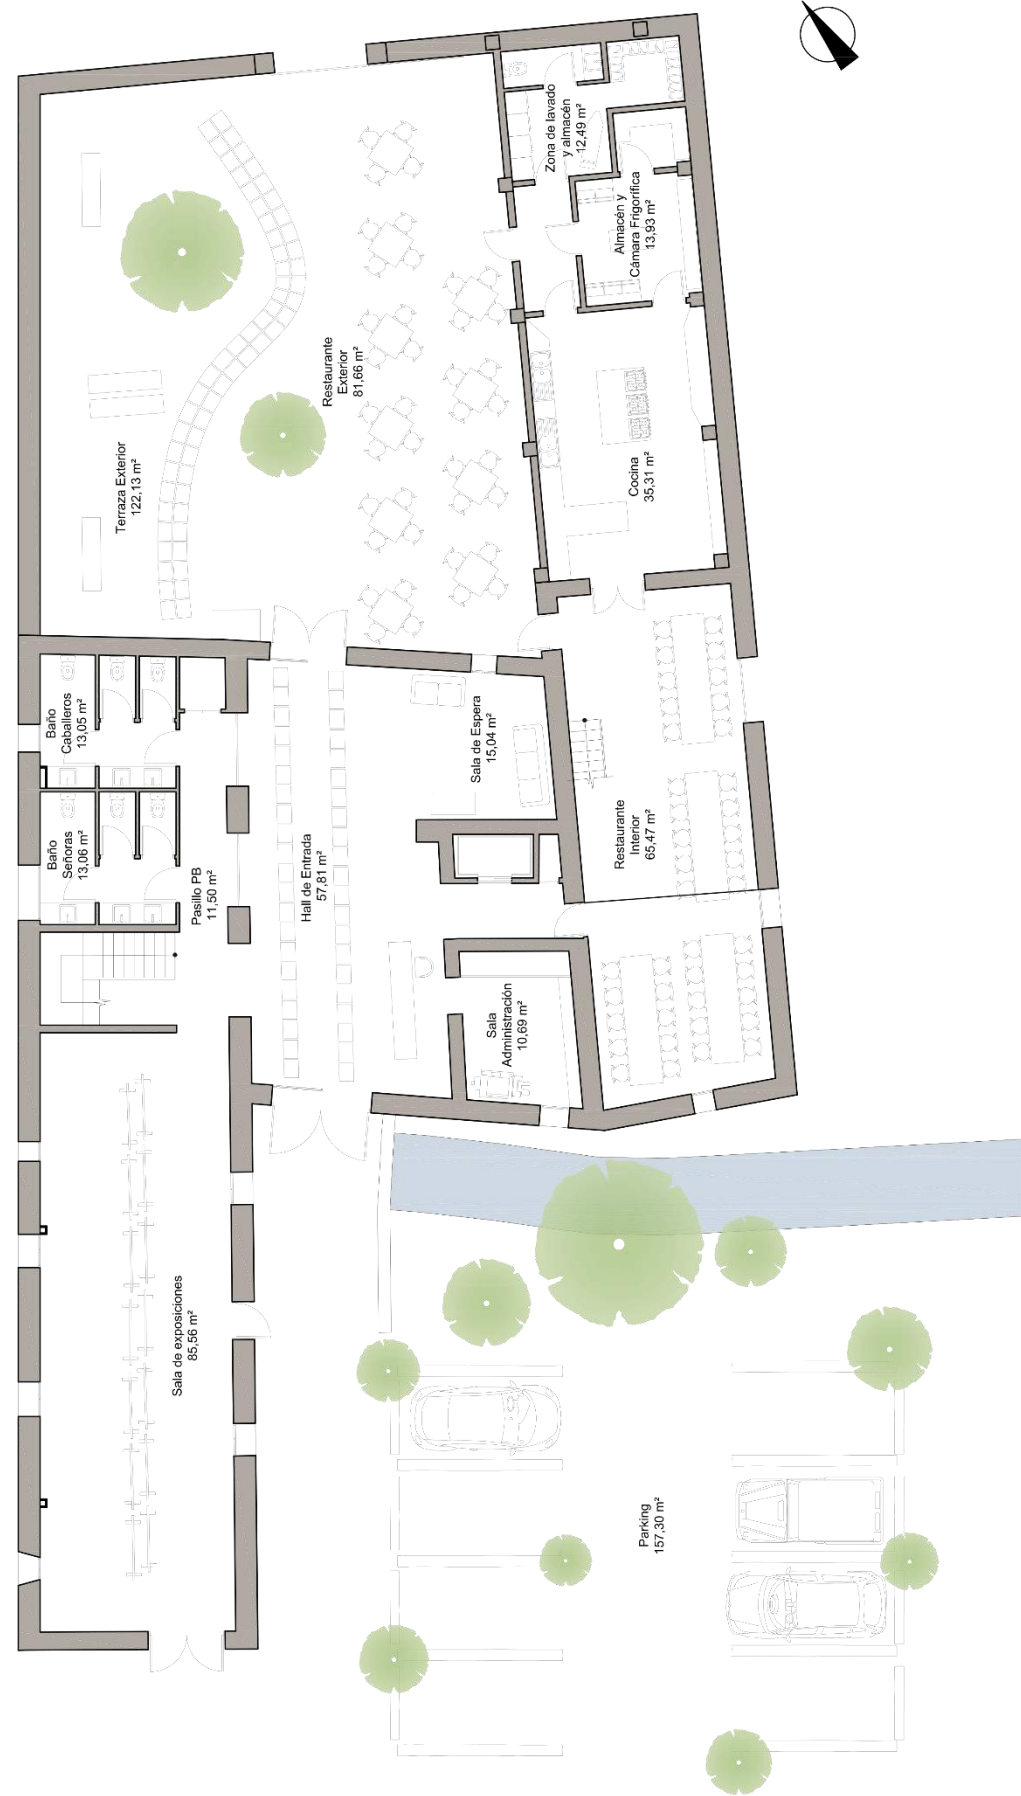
Estado Propuesto Alquería de Farinós. Planta Baja. Autor Propio. 2015.
